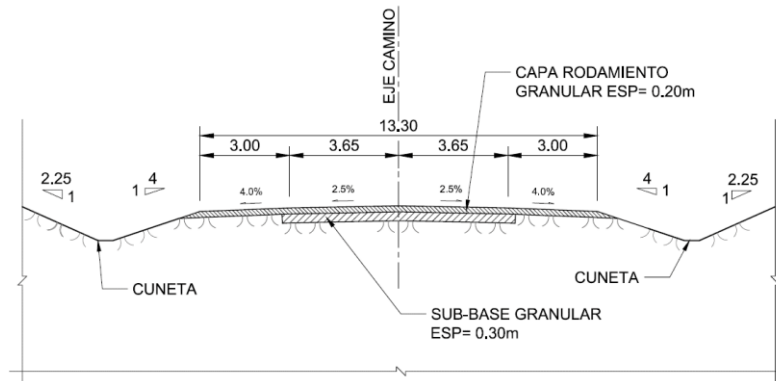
Presa Néstor Kirchner – Detalle de Traza de los caminos de acceso norte y sur
